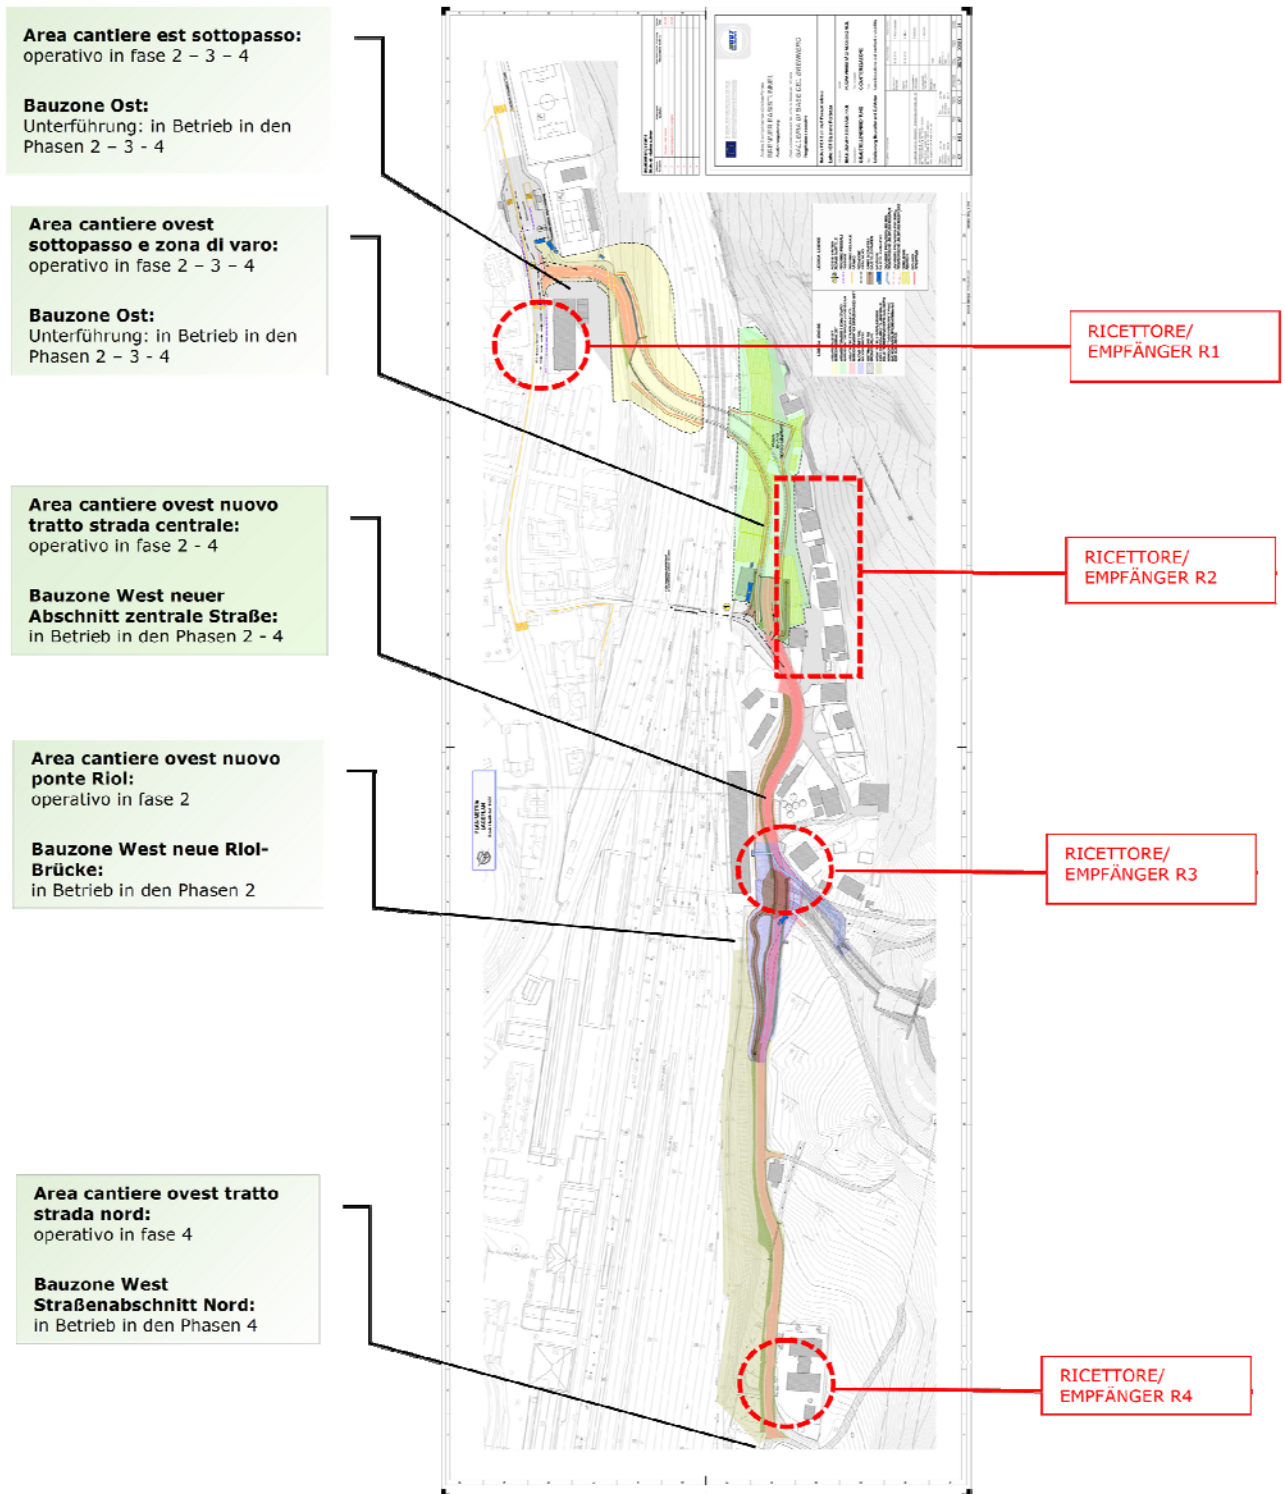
Lageplanermittlung der Baustellenbereiche und der Immissionspunkte
